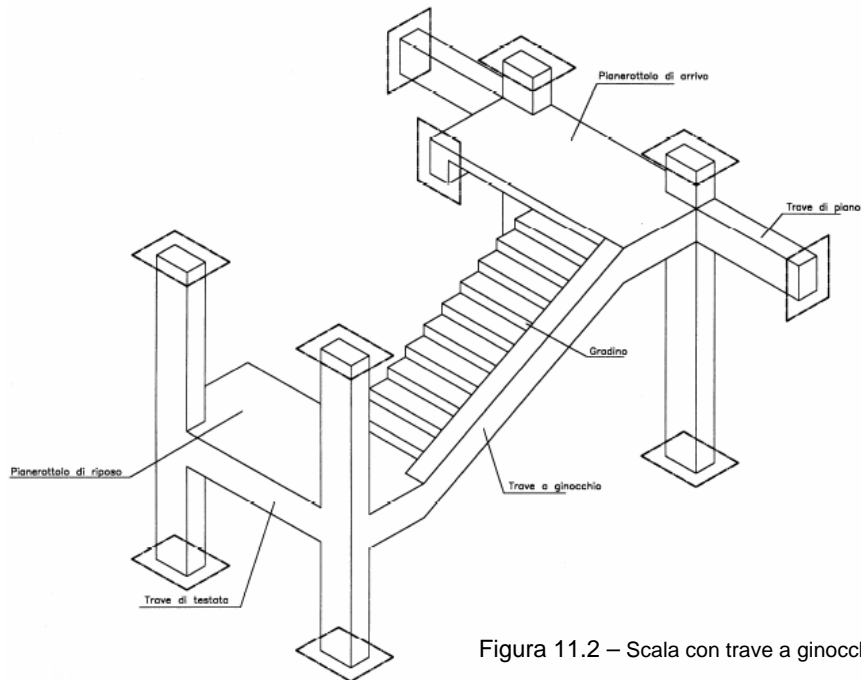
Scala con trave a ginocchi e gradini a sbalzo
